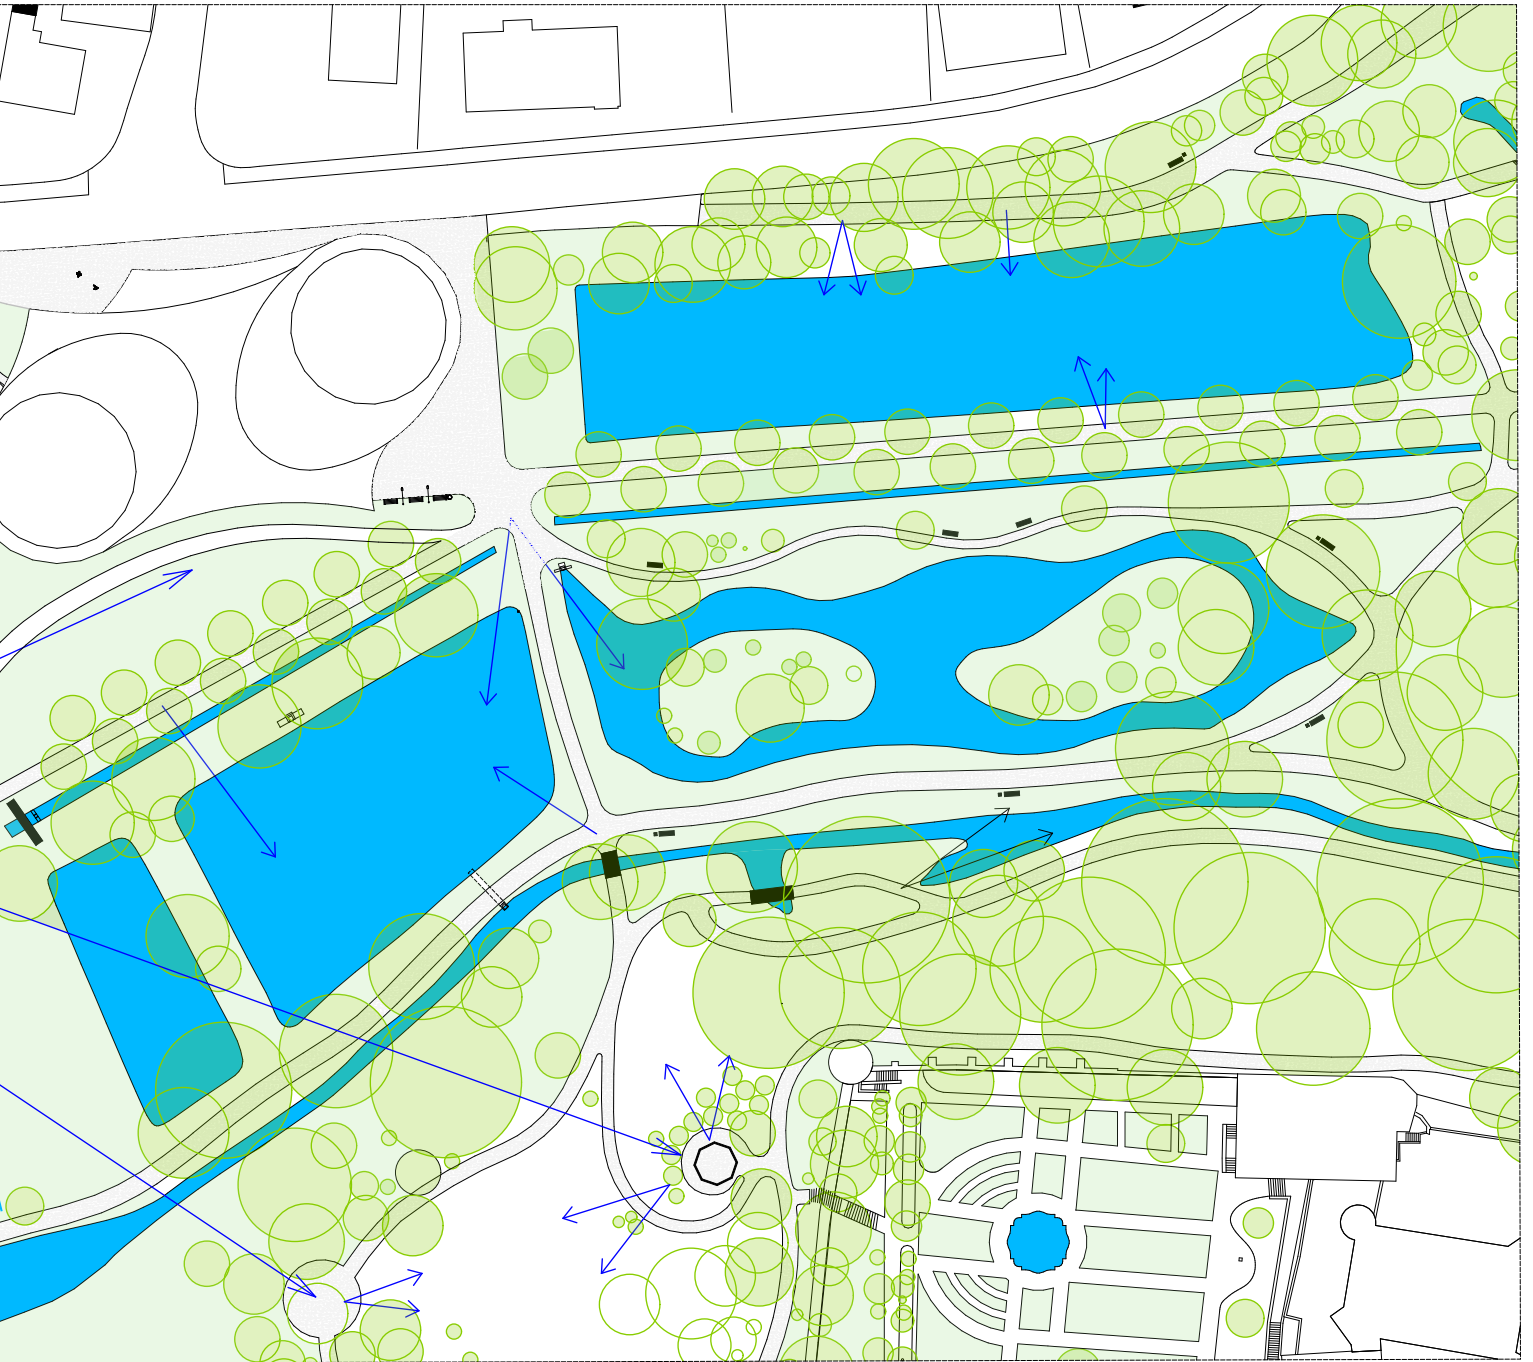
Plan Entwurf mit umliegender Bebauung
